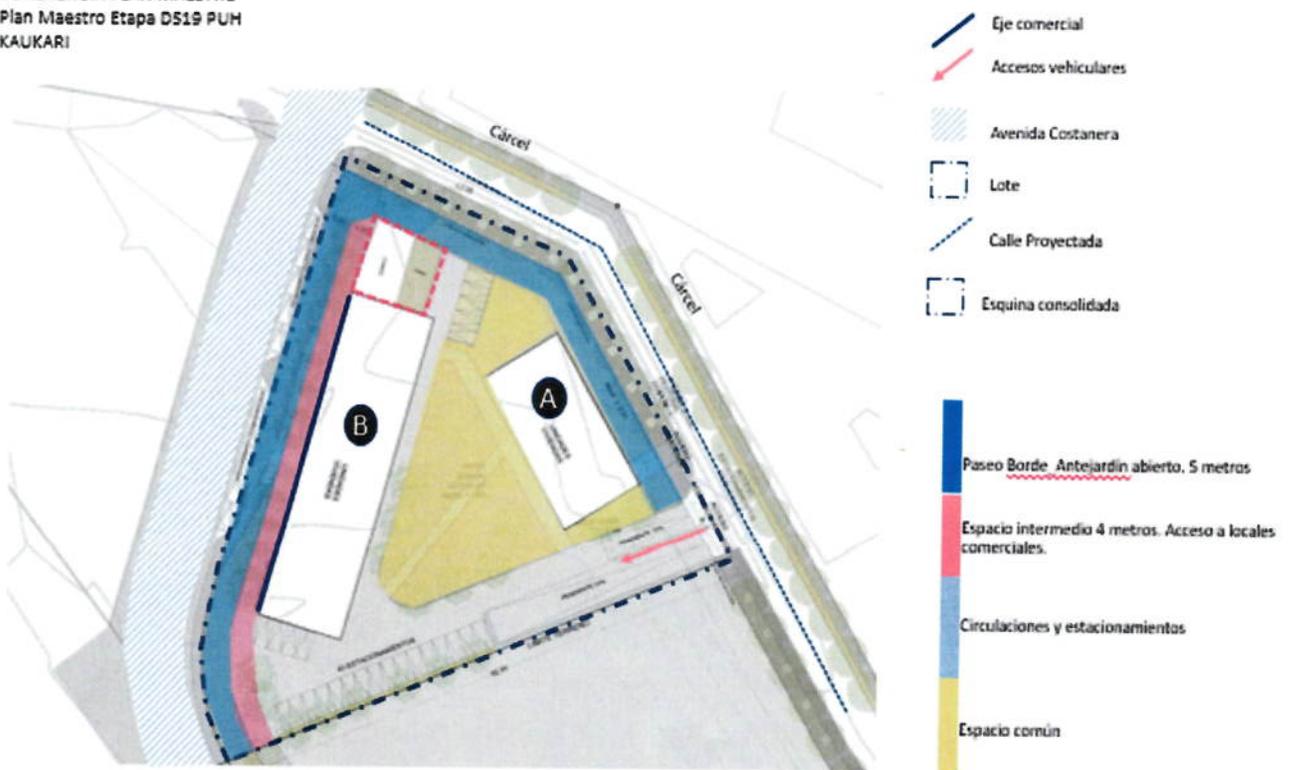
Coherencia Plan Maestro Kaukari , Lote Proyecto DS.19
